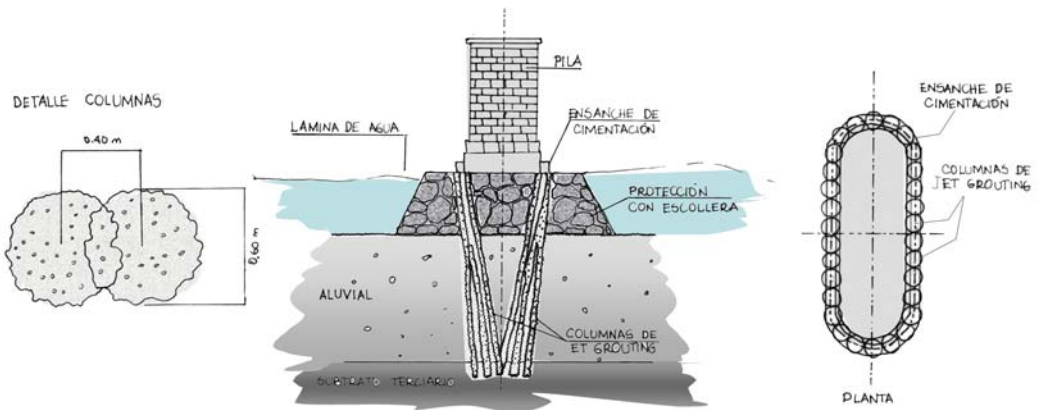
Ejemplos de distribución de las columnas de jet grouting.
